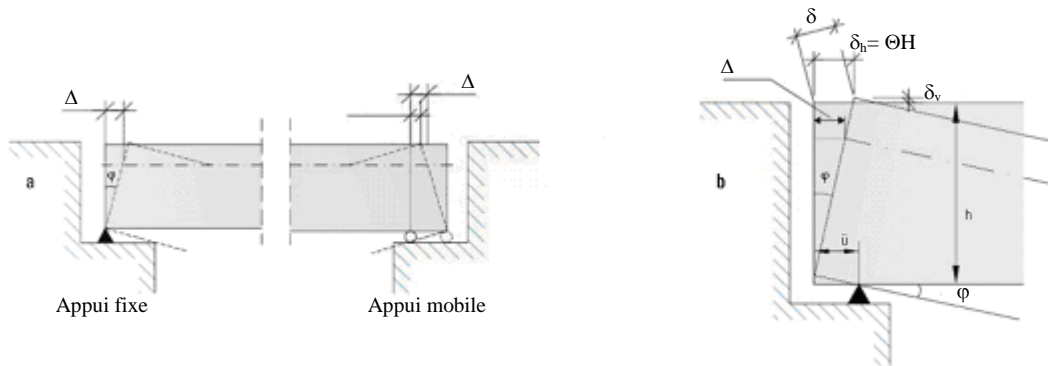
Déplacement horizontal suite à la rotation angulaire
